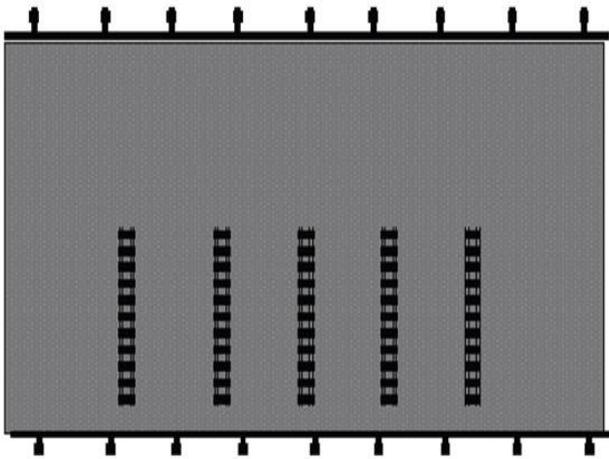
Tramo a pavimentar con las canastas de dovelas instaladas.
